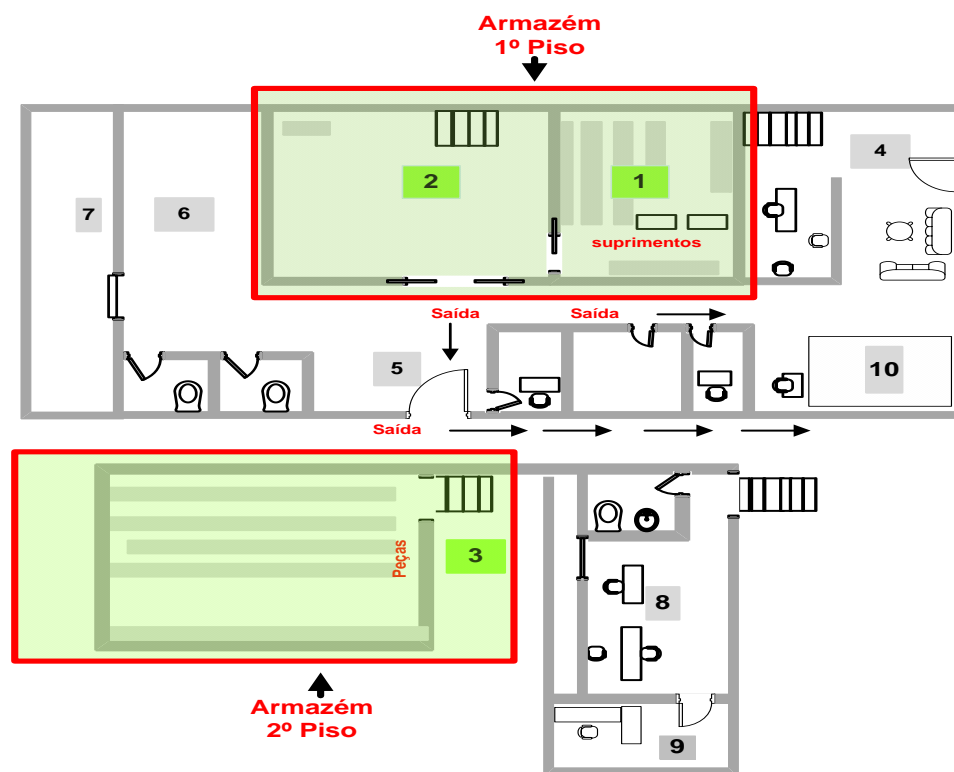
Planta inicial do armazém da Amazoncopy: 1º piso e 2º piso.
